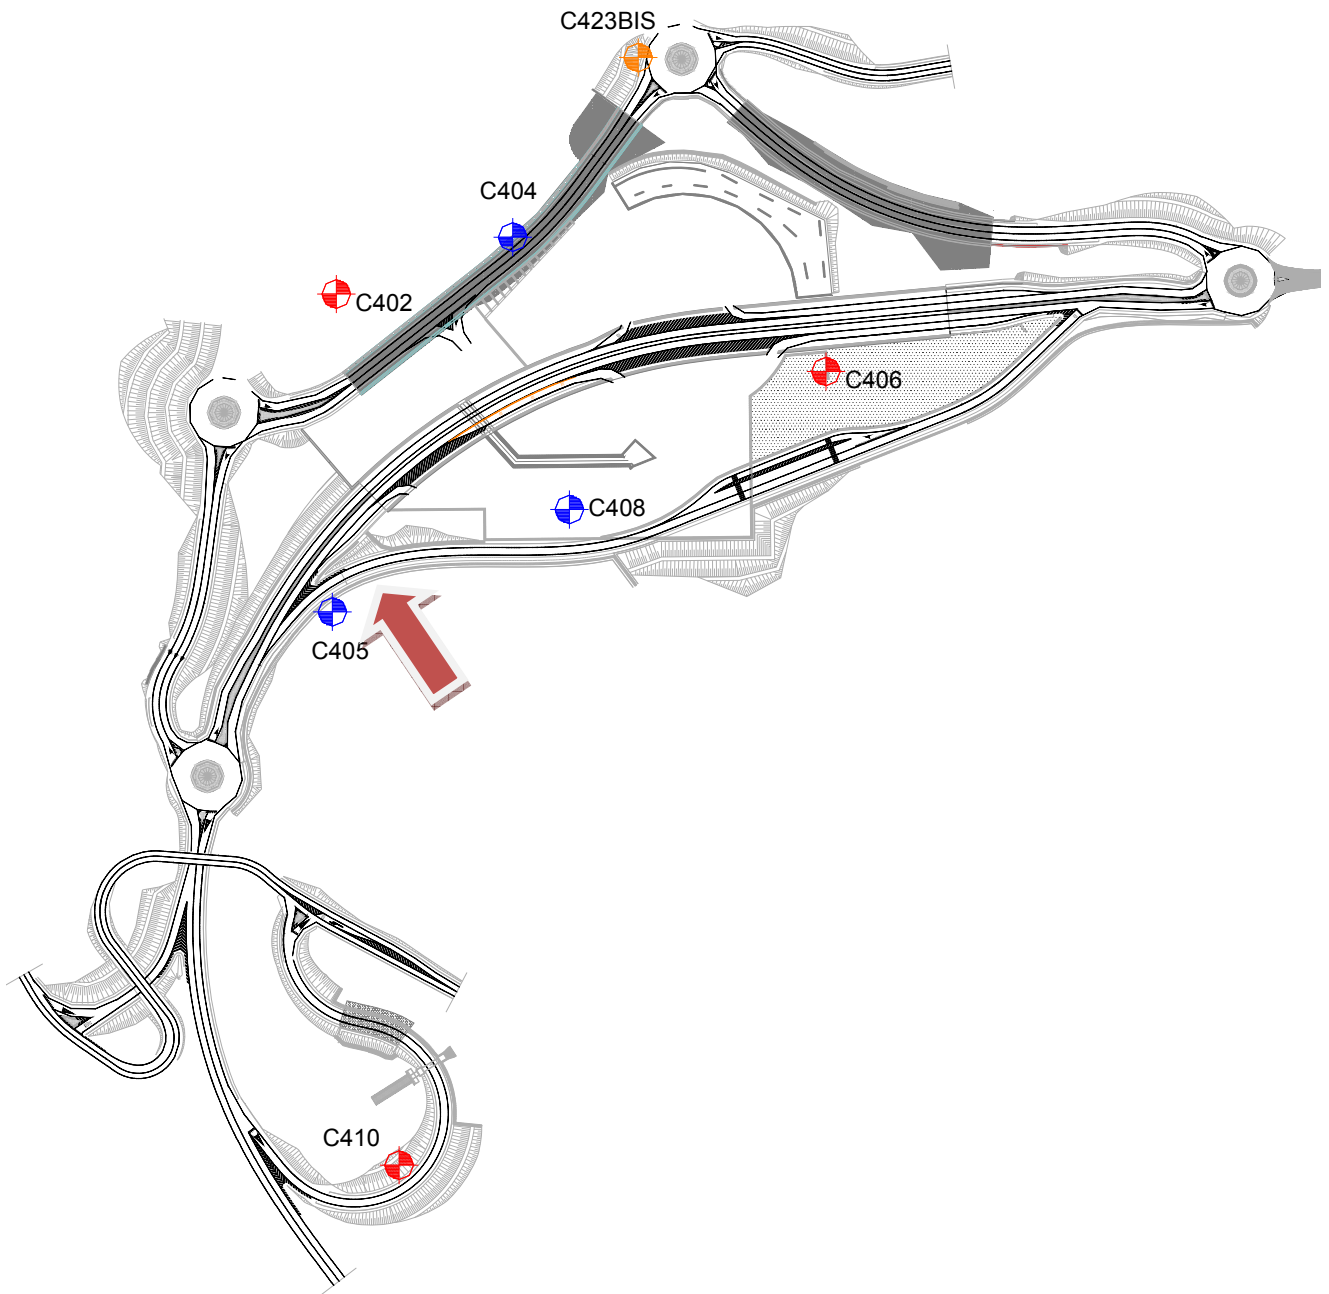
Stralcio planimetrico con ubicazione delle opere e dei sondaggi
